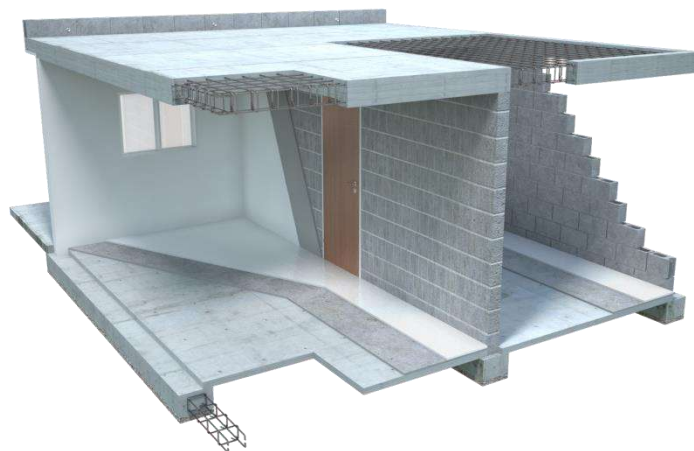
sistema constructivo material moderno tardío. Casa incompleta.
